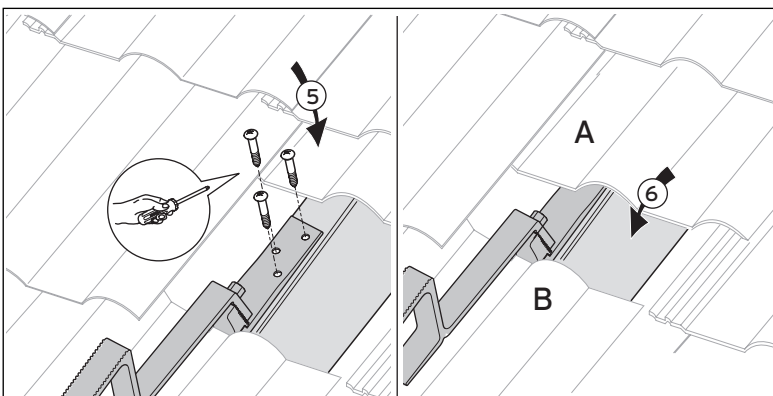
Dachanker Typ P auf dem Dachsparren befestigen
